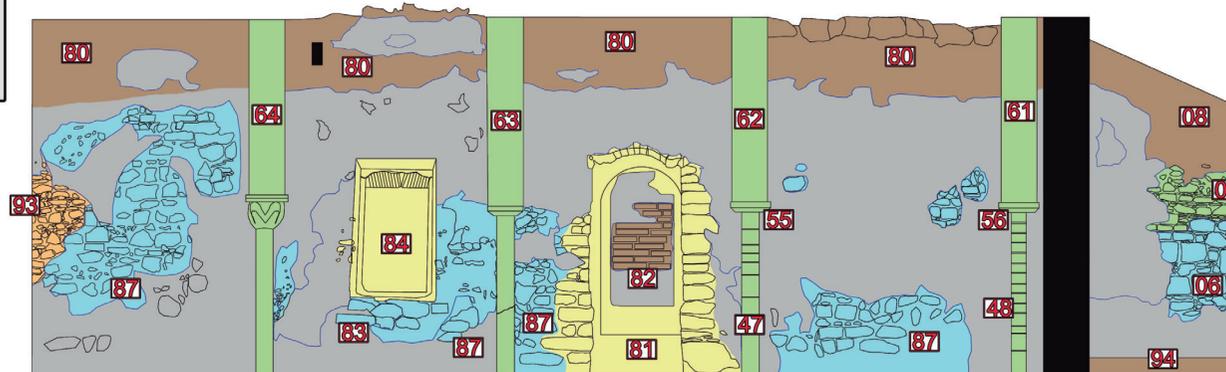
Planimetría 2 del edificio (elaboración propia).
